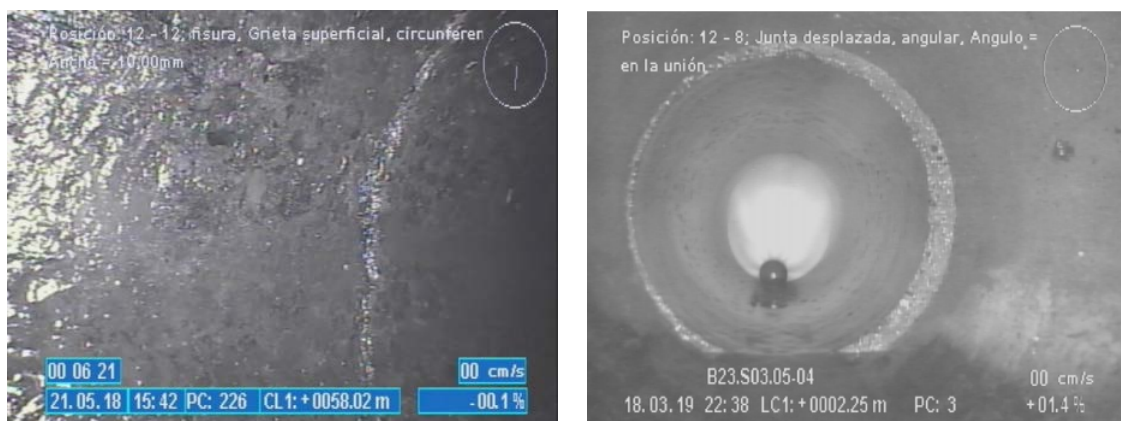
Juntas desplazadas y grietas en un colector 400mm
